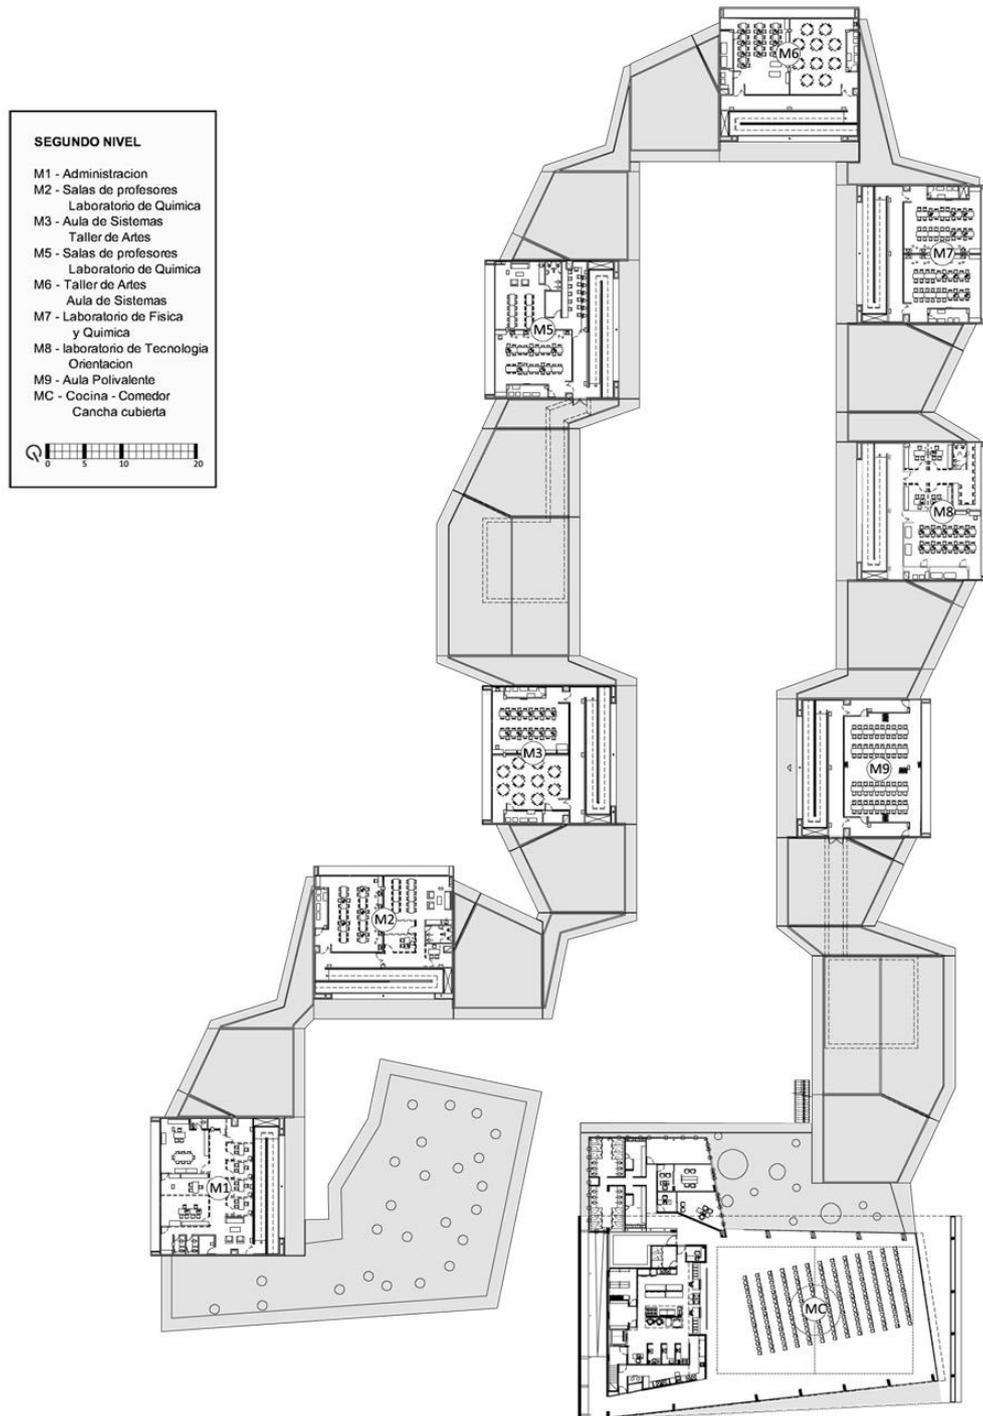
PLANTA SEGUNDO NÍVEL
